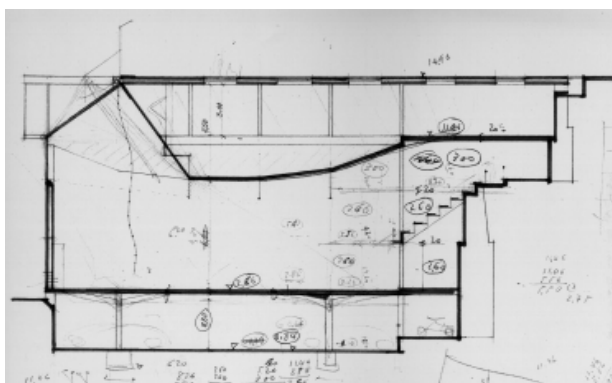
Croquis de Sota con viga Viereendel y descuelgue de estructura triangulada. Se aprecia la intención del lucernario con ese gesto de separación de la fachada.
